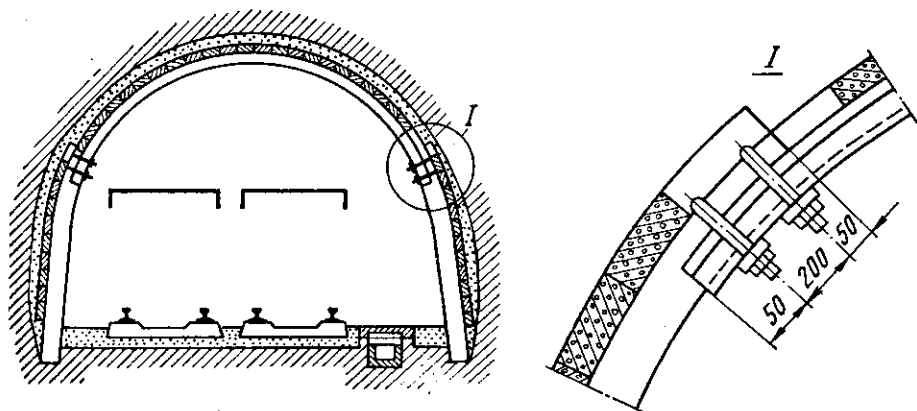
Смешанная арочная податливая крепь из железобетонных стоек и металлического верхняка
